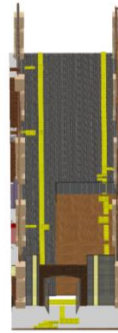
Penerapan *Handrail*, *Guiding Block*, Pencahayaan Pada Koridor (Penulis,2017)
